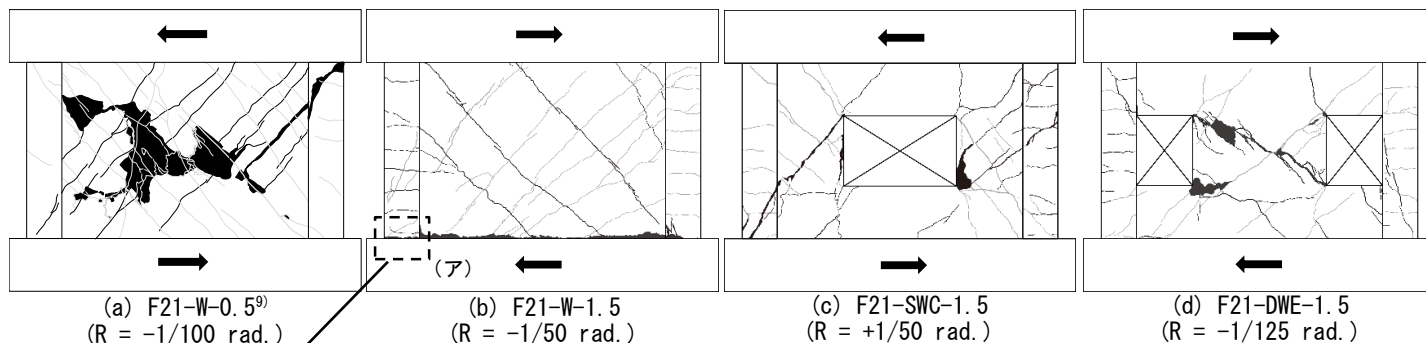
反曲点高さ比 1.5 の普通強度試験体の実験終了時のひび割れ状況図 (→:実験終了時の加力方向)
